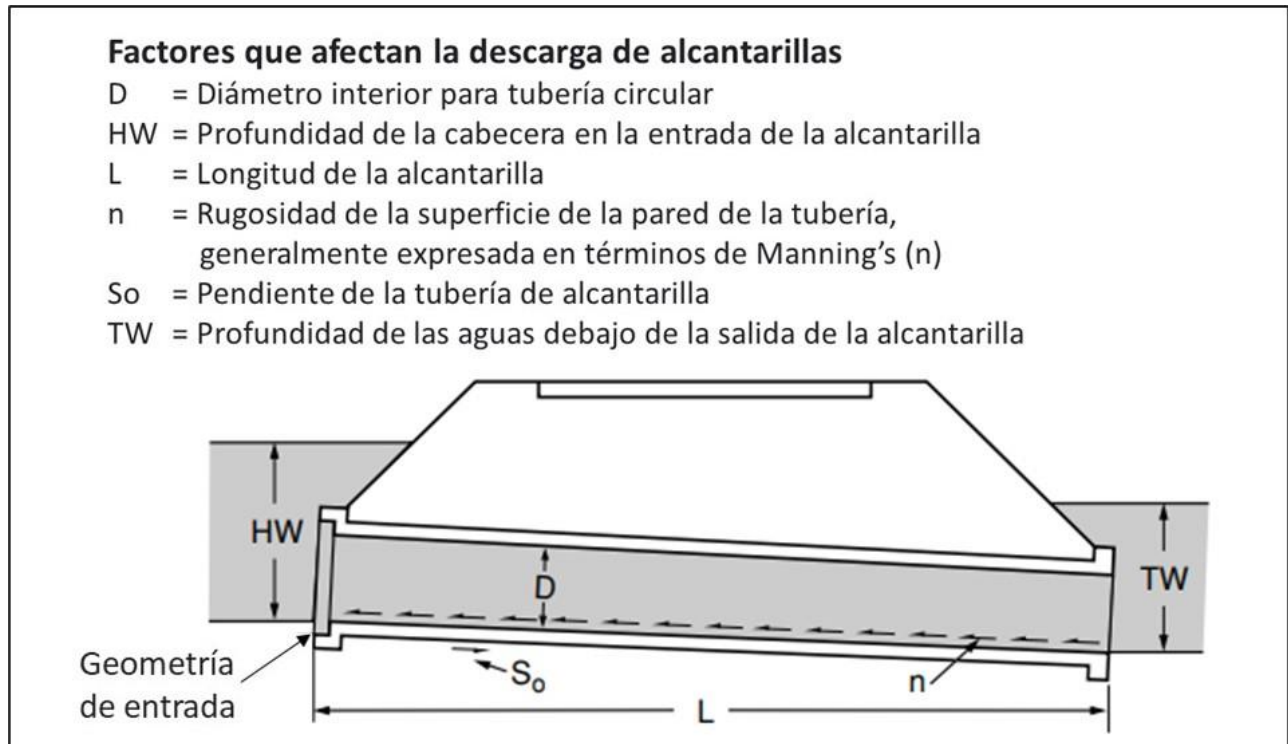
Obra de drenaje transversal para el camino de acceso al Pozo Kinkan-1EXP (*Manuel de diseño de tubería de concreto- American Concrete Pipe Association*).
